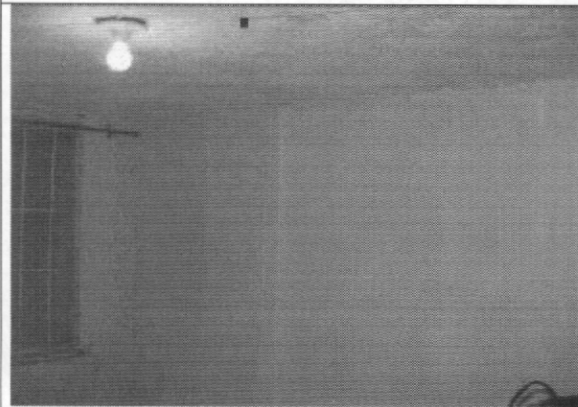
Muros de segundo piso en buen estado, apartamento costado occidental
